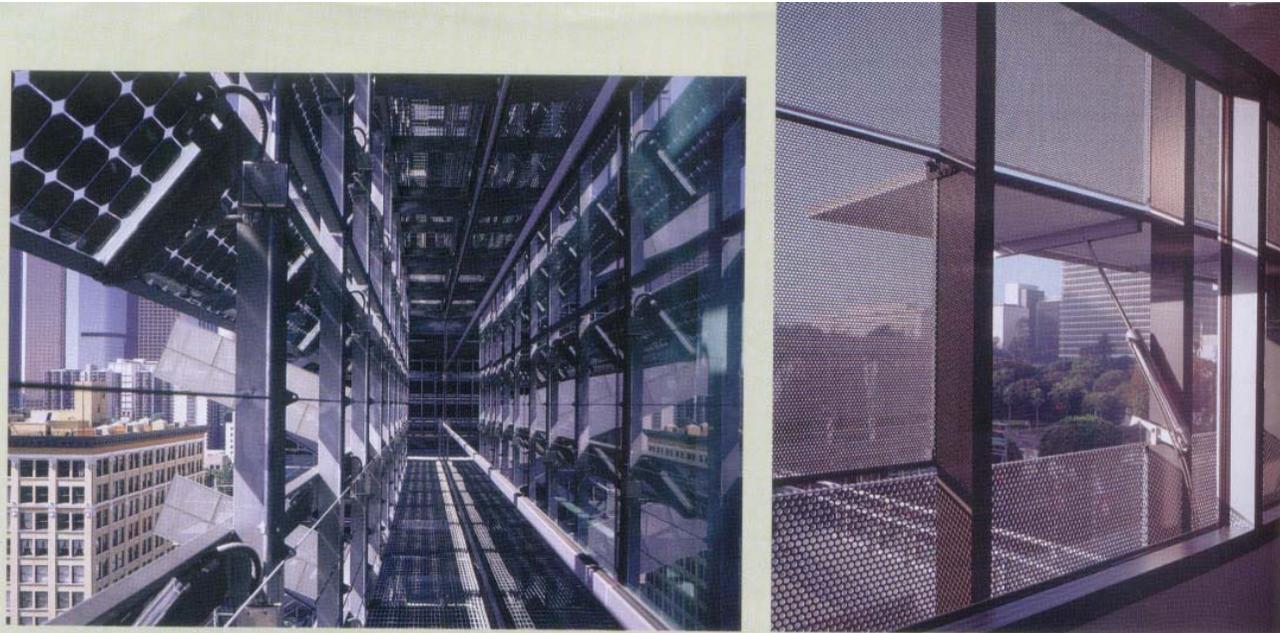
e 57: Instituto de Biodesign. Fonte: REVISTA ARCHITECTURAL RECORD, 2006.
